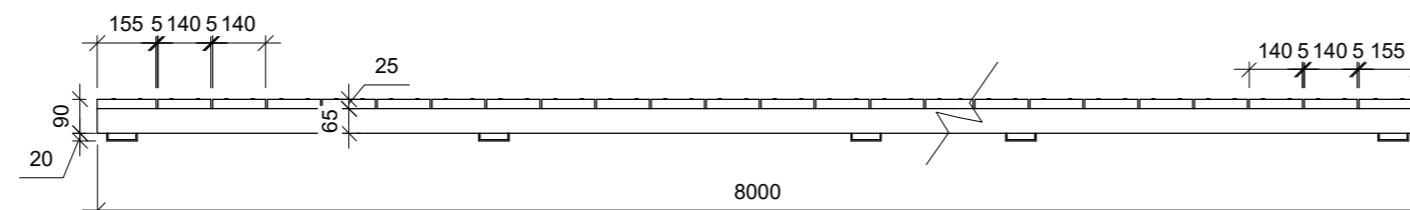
DETAIL ULOŽENÍ KONSTRUKCE M 1:20
